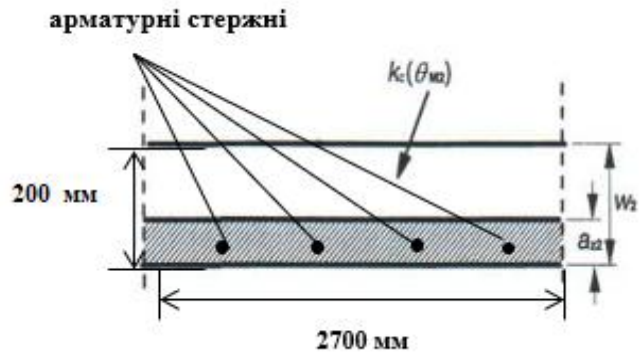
Приведений поперечний переріз залізобетонної стіни.
